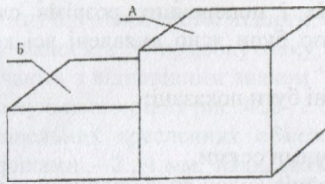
Спряжені впритул будівлі: А – висота будівлі 6,0 м, довжина – 18 м; Б – висота будівлі – 4,8 м, довжина – 12 м.
